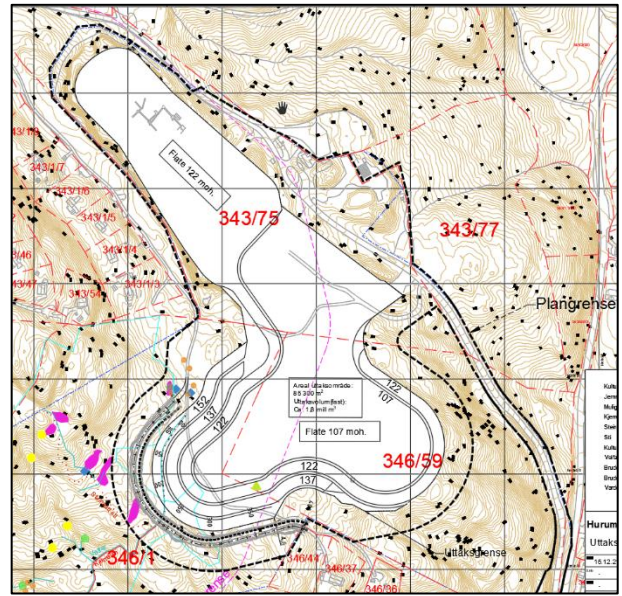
Alternativ 2 (planforslaget) - Fase 1
